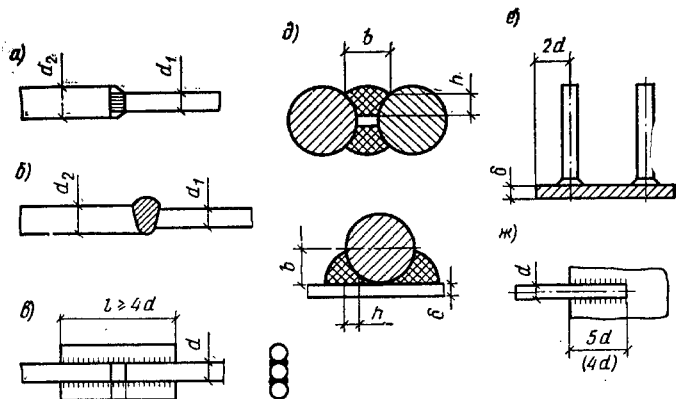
Сварные стыковые соединения арматуры
